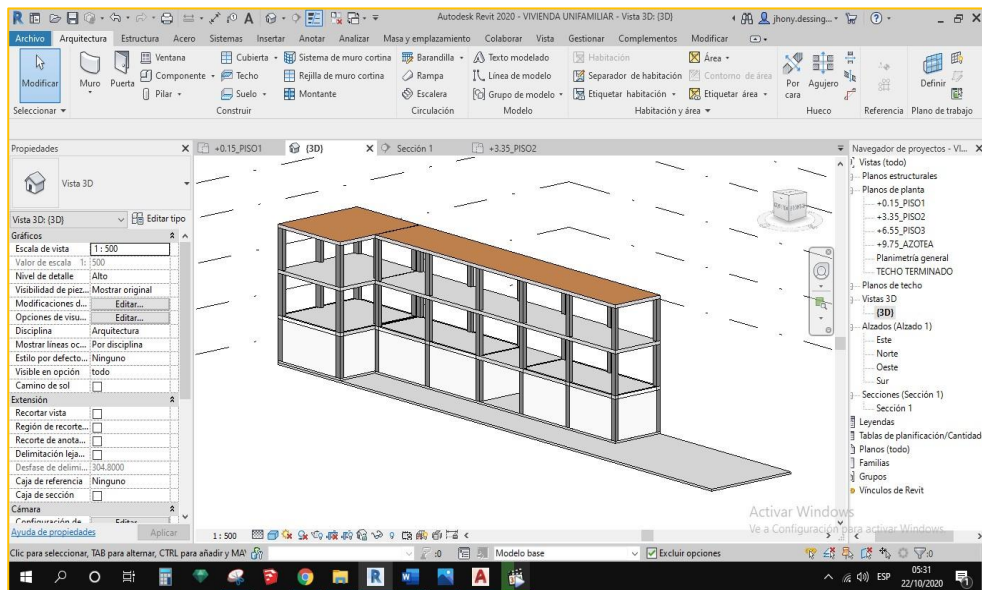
Vista en isométrico de muros junto a pilares arquitectónicos y losa aligerada.
